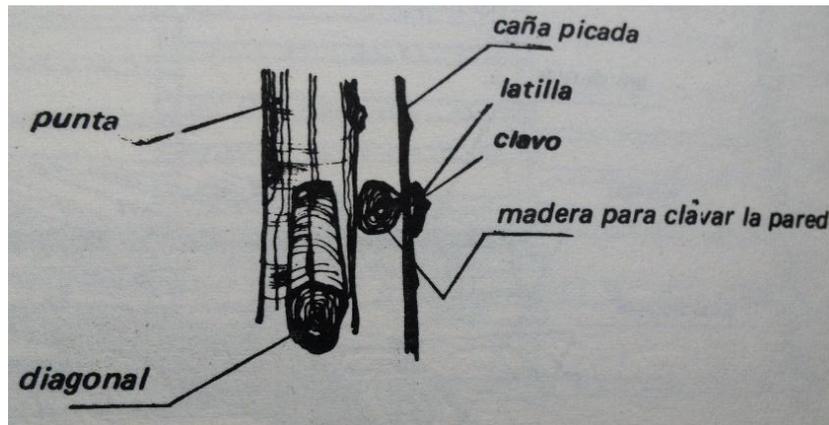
Estructura de piso Vivienda Flotante
